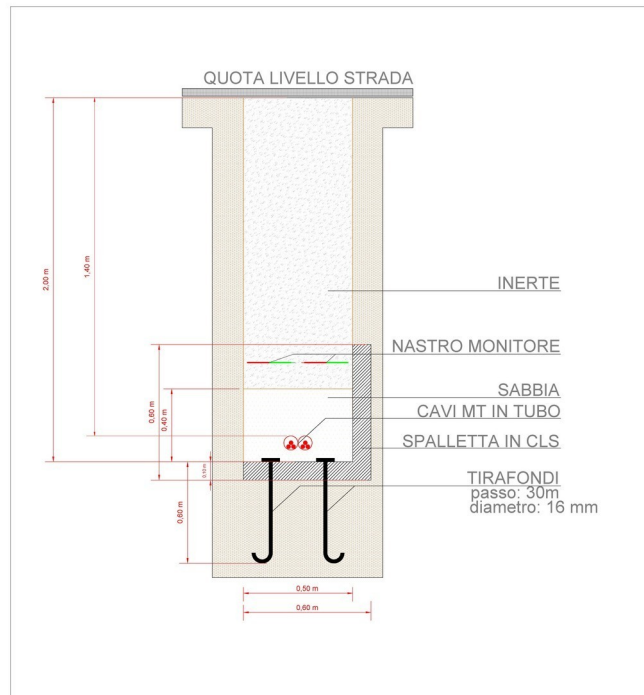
Particolare sezione tipo cavo interrato MT e particolari della sezione stradale
